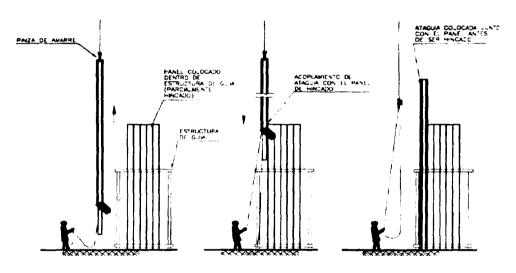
ENFILADO DE PANELES A COLOCACION DE AIAGUIA DENTRO DE LA ESTRUCTURA DE AIAGUIA
